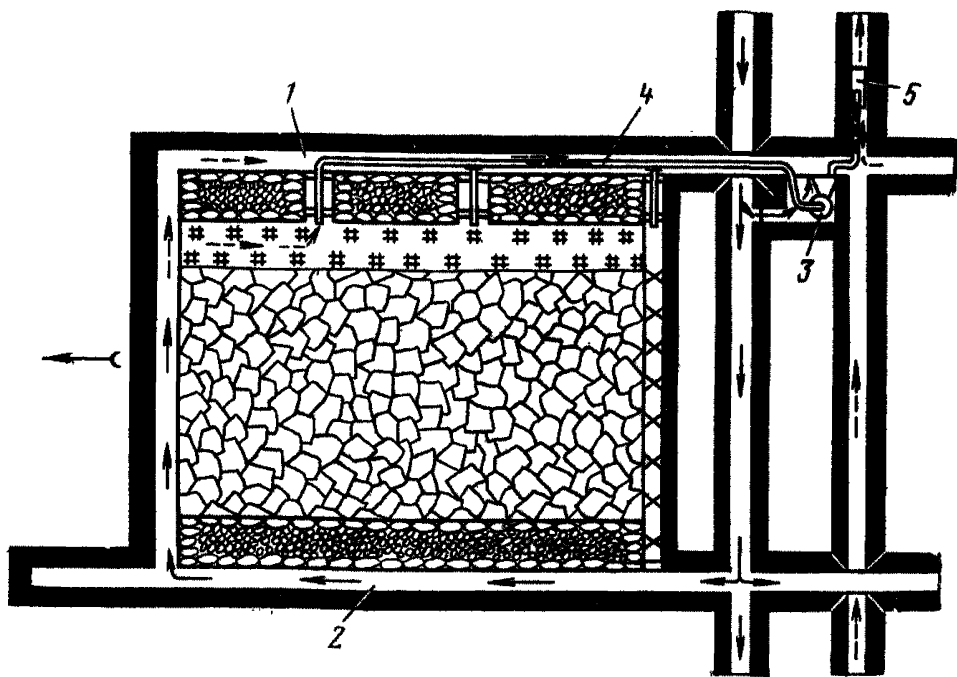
Схема изолированного отвода метана при сплошной системе разработки:
